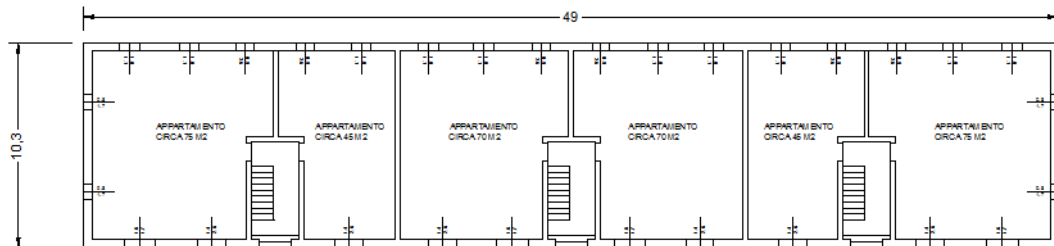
Planimetrie Edificio Tipo 1.2
